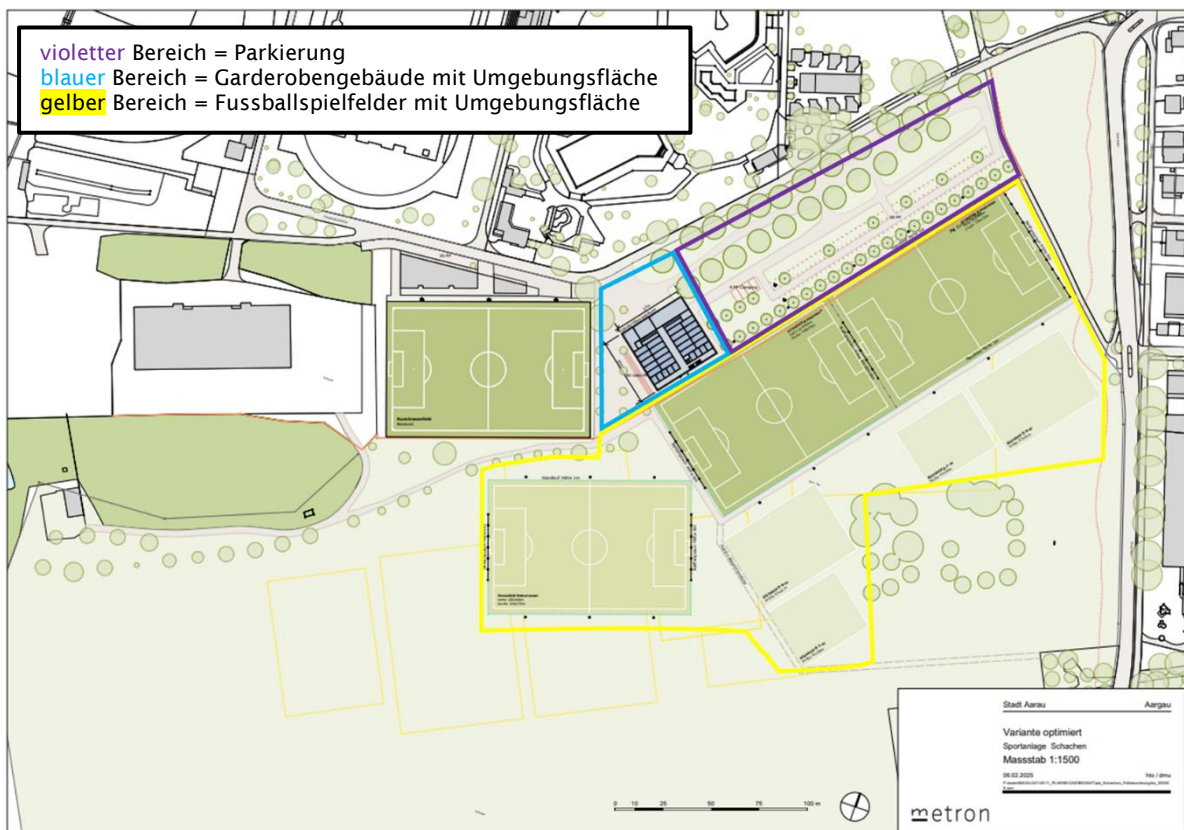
Zielvariante; violetter Bereich = Parkierung, blauer Bereich = Garderobengebäude mit Umgebungsfläche, gelber Bereich = Fussballfelder mit Umgebungsfläche
